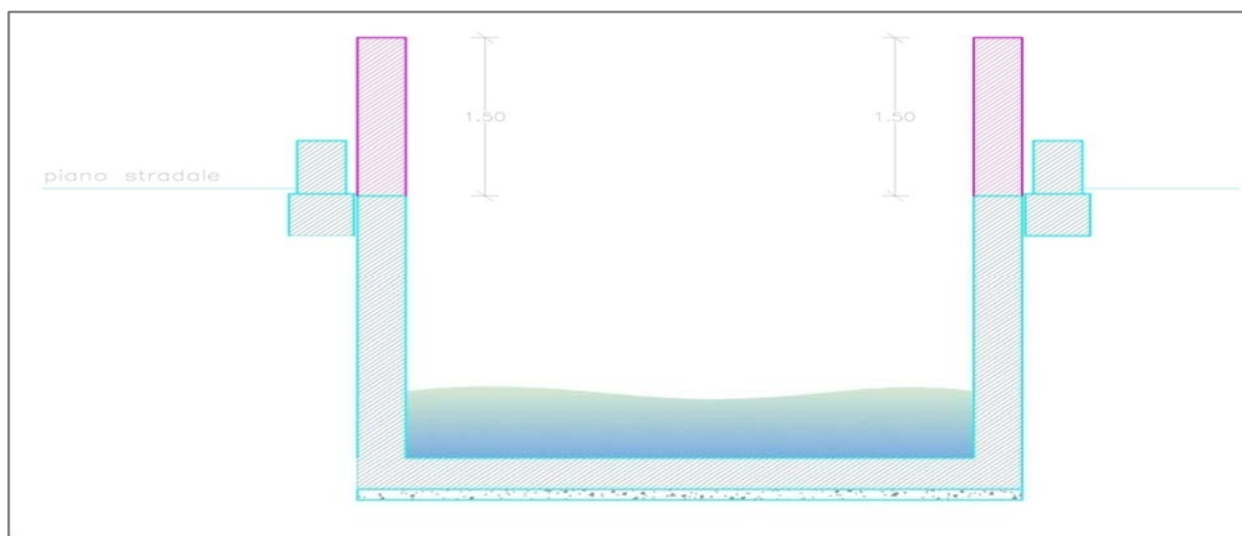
Sezione del canale a seguito dell'innalzamento delle sponde.
